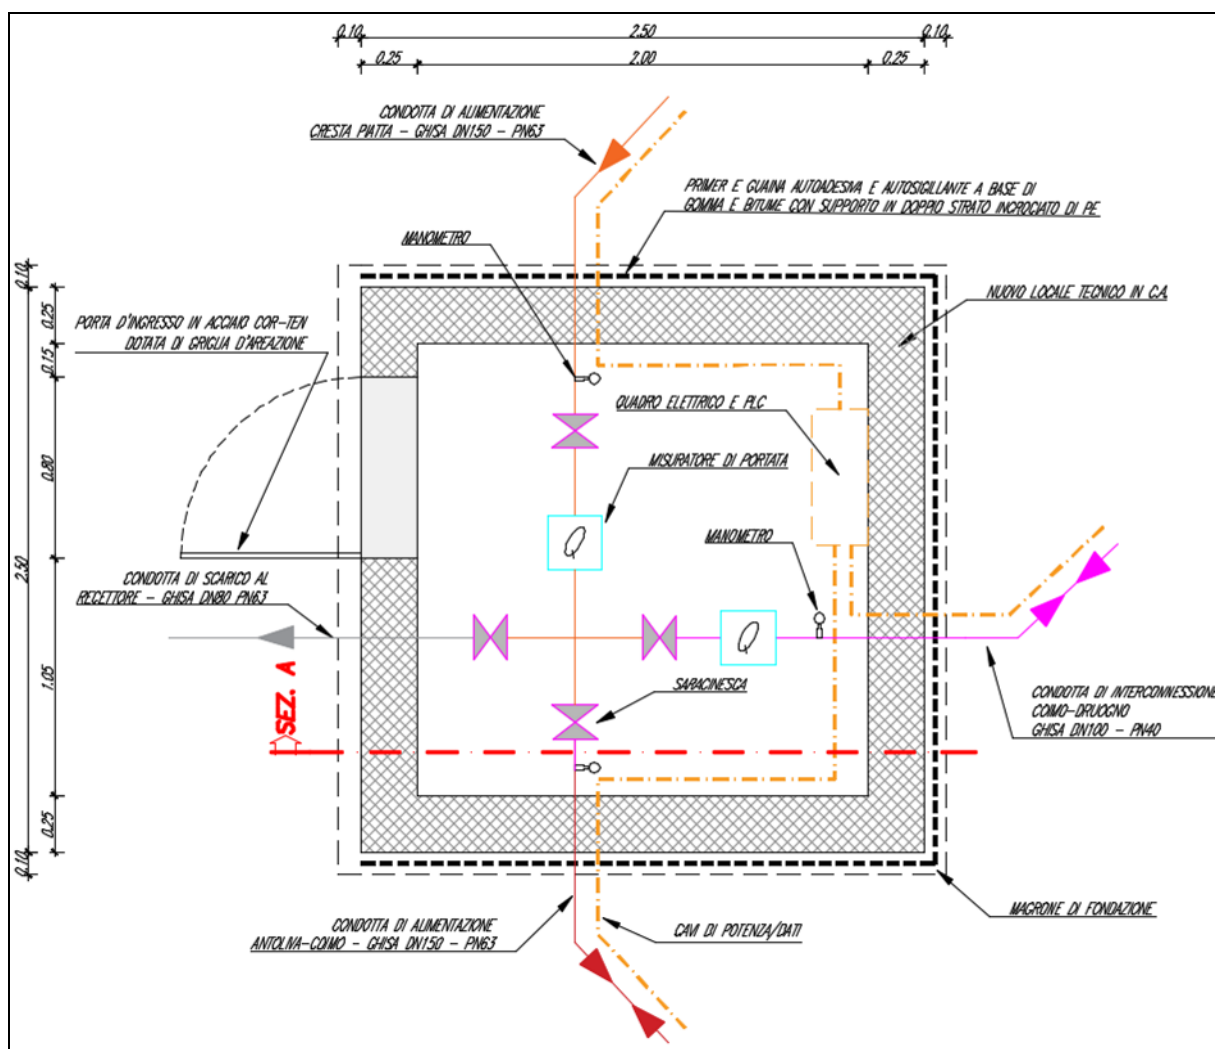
Pianta di progetto del nuovo locale tecnico previsto in via Curti a Coimo
